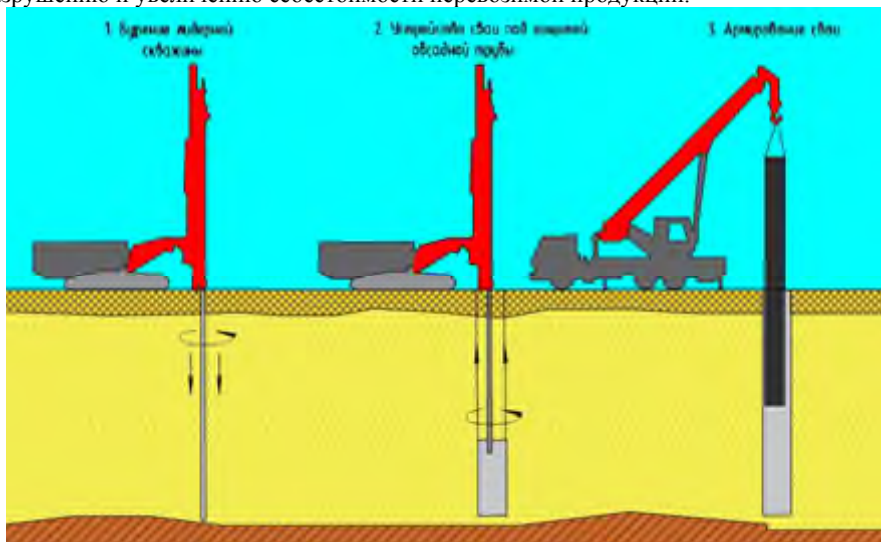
Устройство грунтовых свай в теле насыпи подхода
